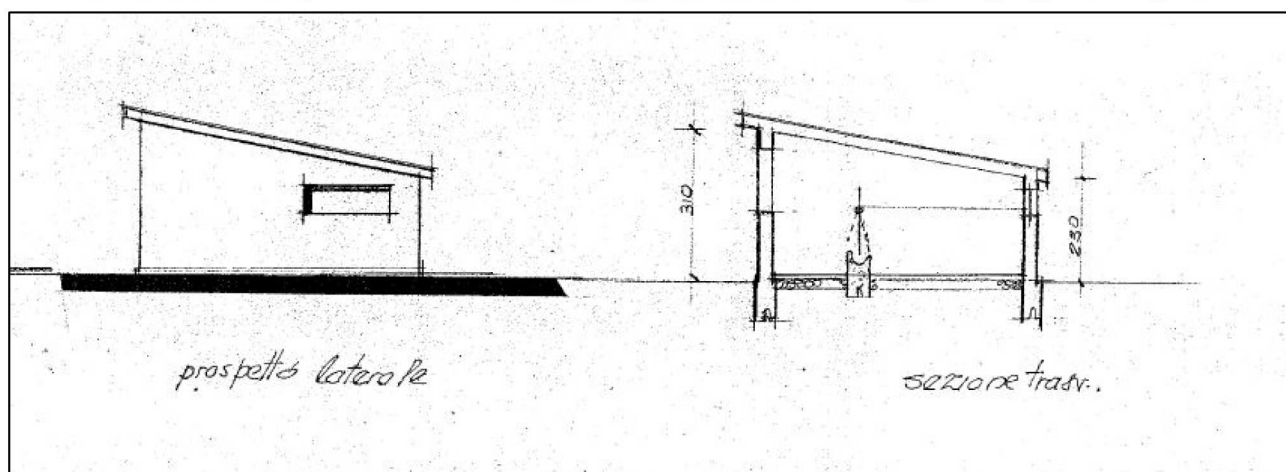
Sezione e prospetto laterale stalla - Licenza a costruire in variante n. 24bis del 18.07.1973
